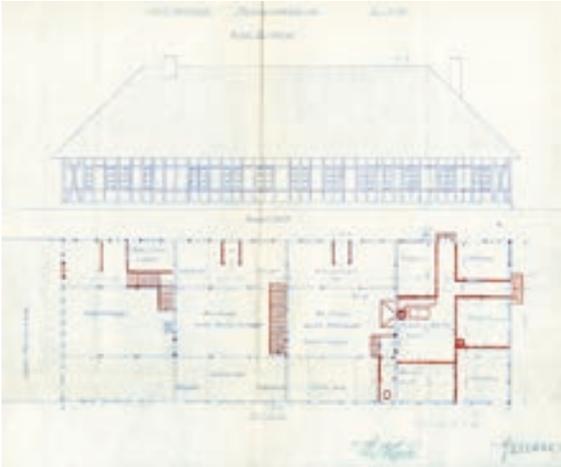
Dienstgebäude für Hochbau, Tiefbau und Wasserwerk. Planzeichnung vom 12.12.1947.
